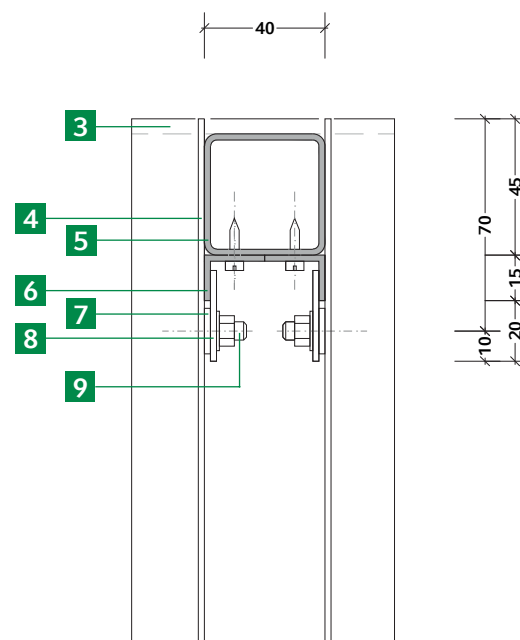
Gebäudekennzeichnung mit Standrohr Detail 03
